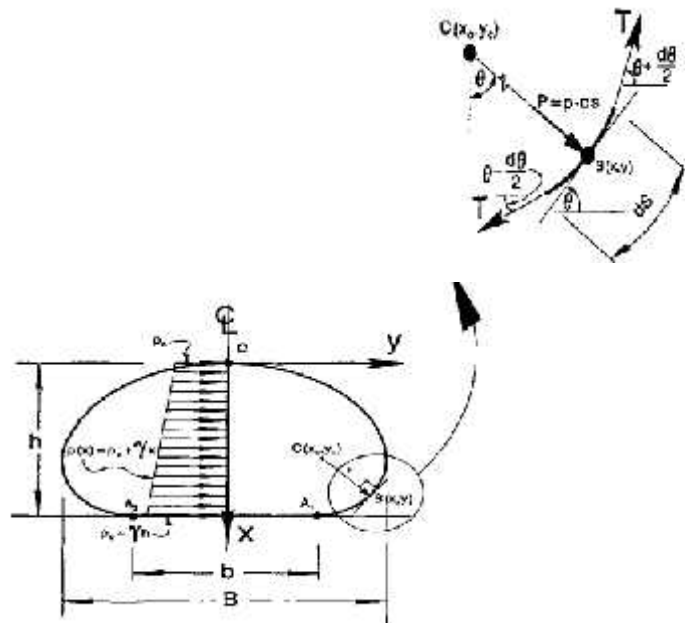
Vista de la sección transversal del tubo geotextil.
